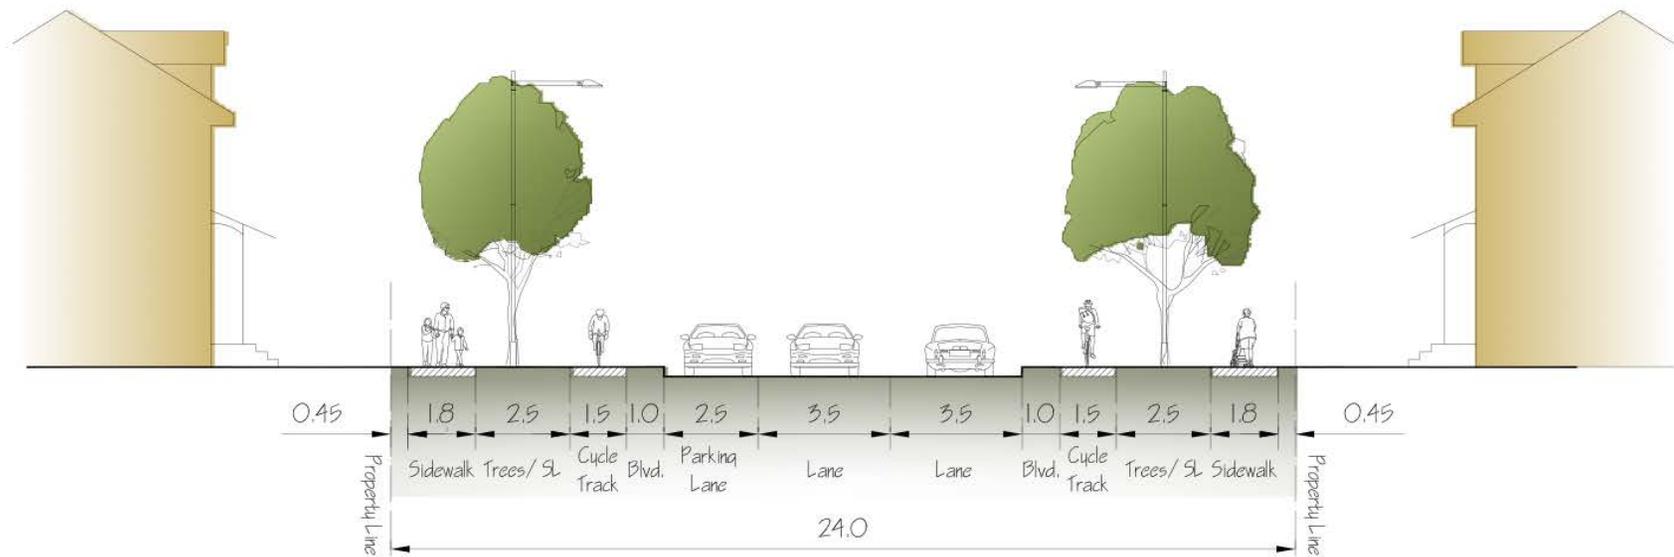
Vue en coupe d'une route collectrice (24,0 m)
